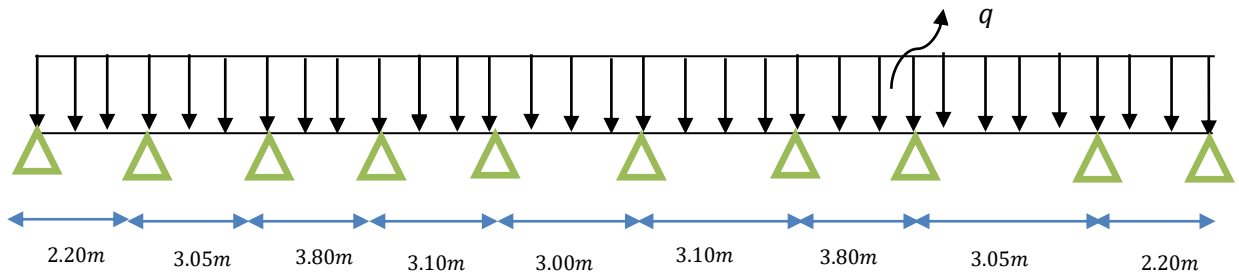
Schéma statique de la poutre appuyée sur 10 appuis.
